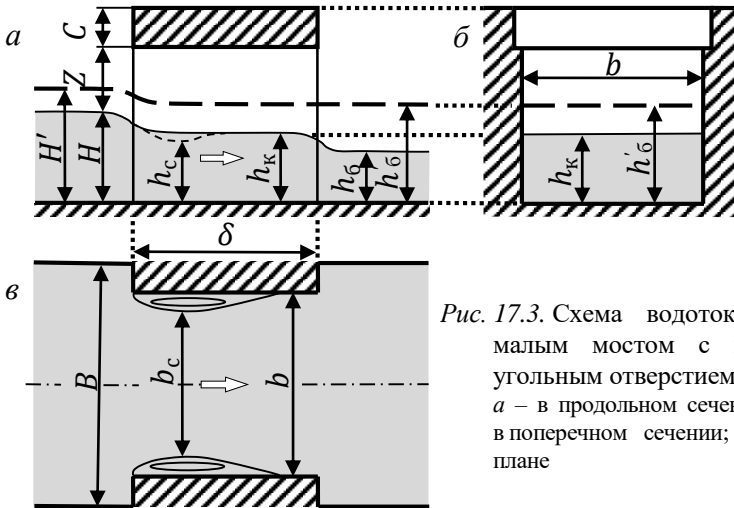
Схема водотока под малым мостом с прямоугольным отверстием: а – в продольном сечении; б – в поперечном сечении; в – в плане
